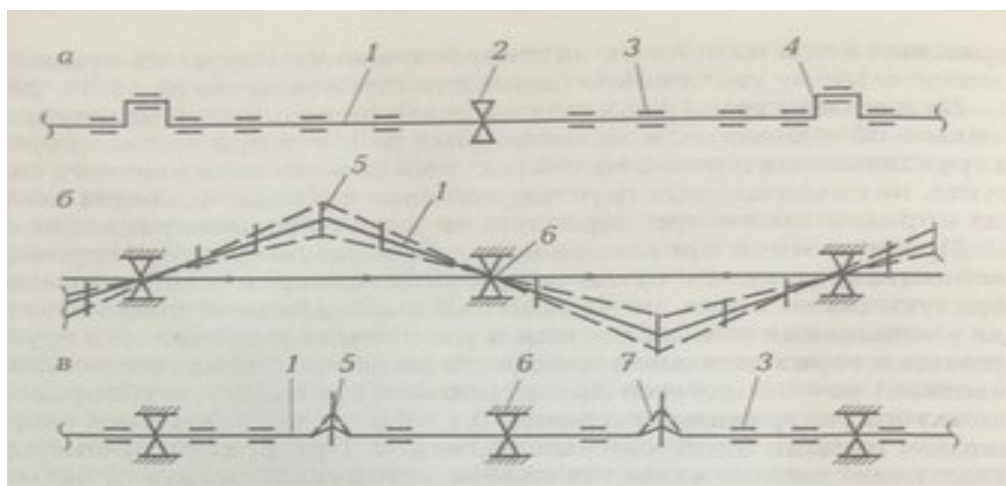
Наземные схемы прокладки трубопровода
